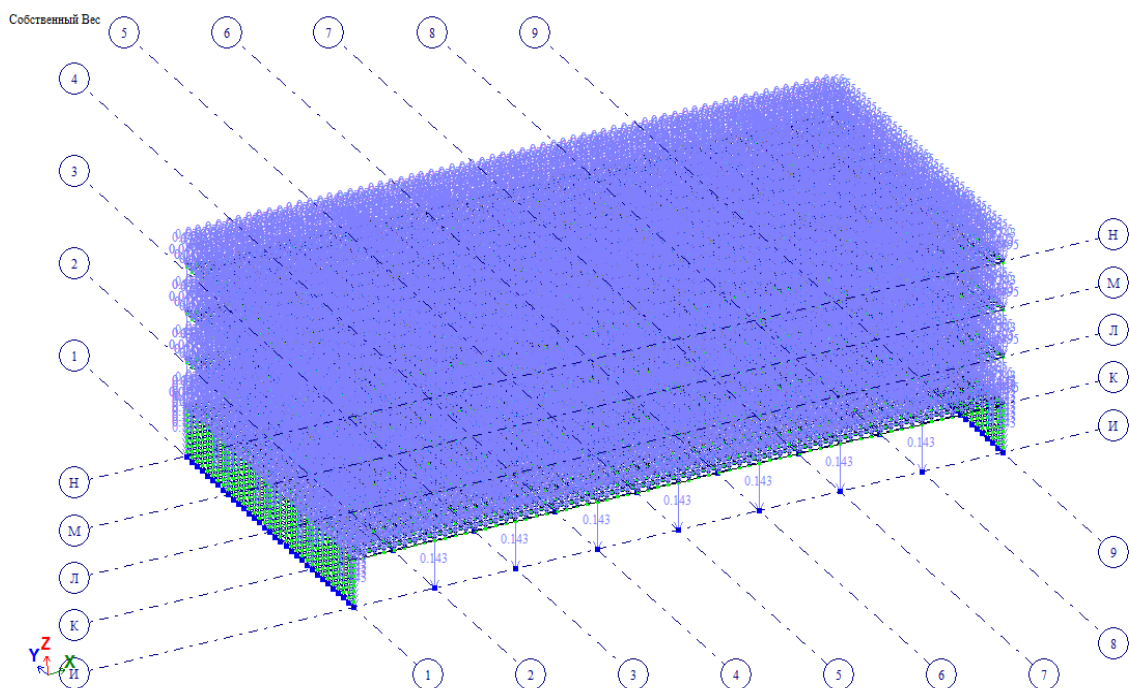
Собственный вес металлических и железобетонных конструкций
